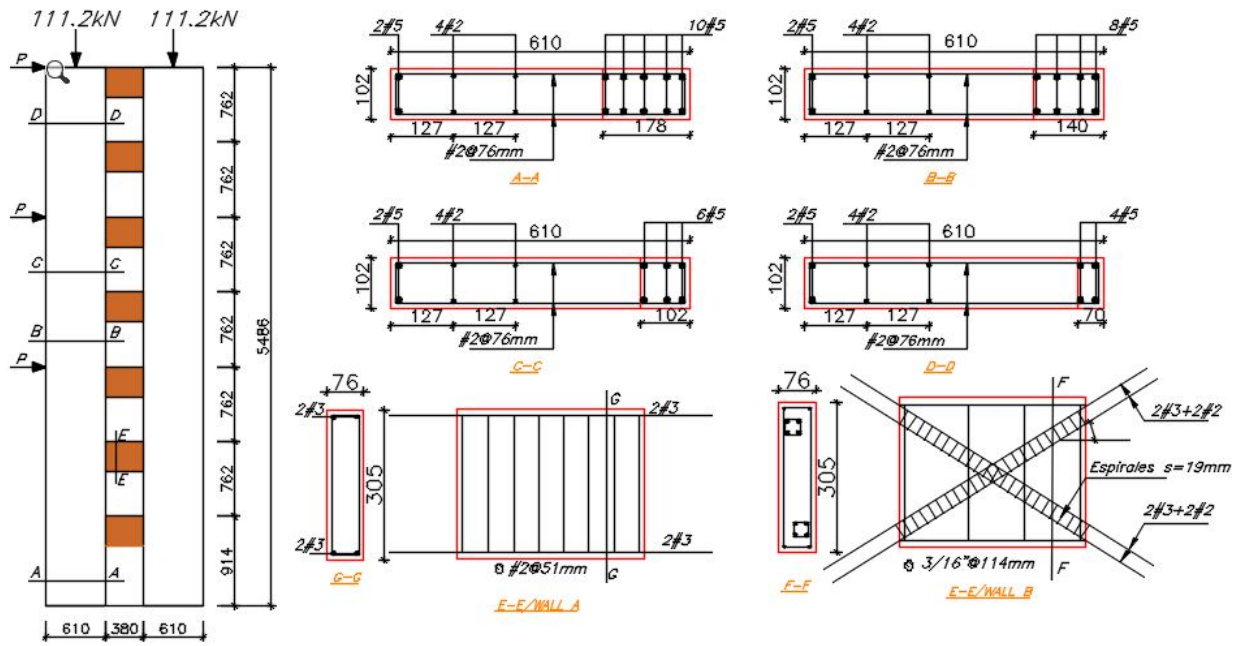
Geometría y detalles de refuerzo de especímenes Wall A y Wall B (modificado de [11])
